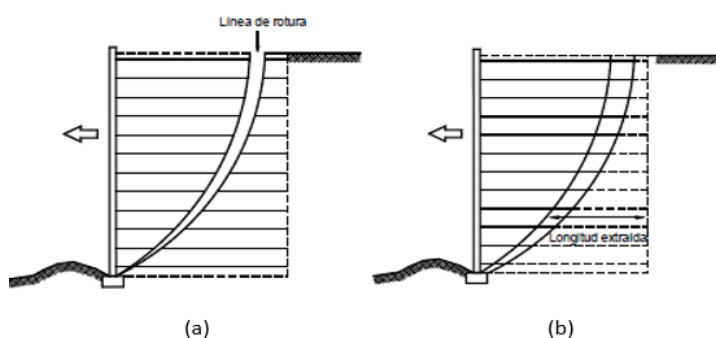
(a) Rotura por refuerzo y (b) Extracción del refuerzo
